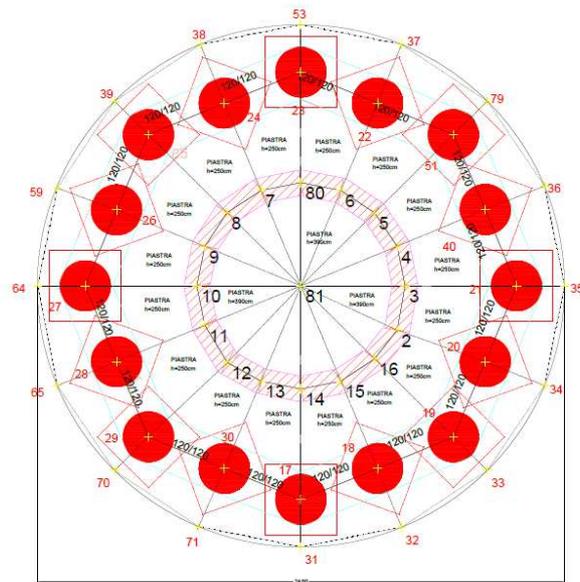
Tipico della fondazione delle WTG (D_3.15_FONDAZWTG)
